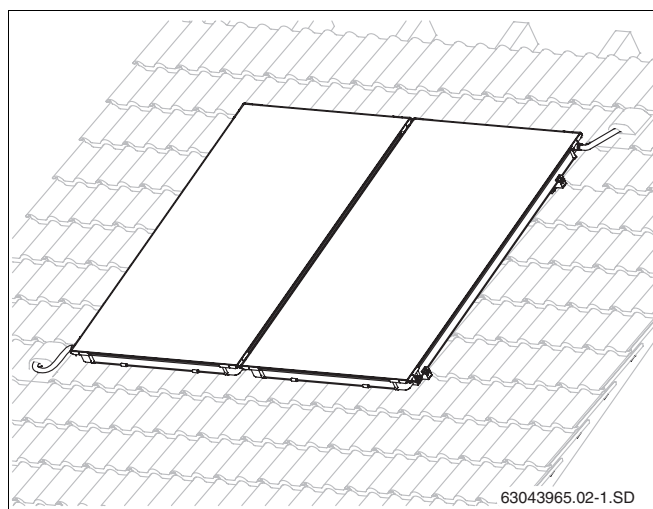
Imagem geral do conjunto de colectores, instalação sobre o telhado
